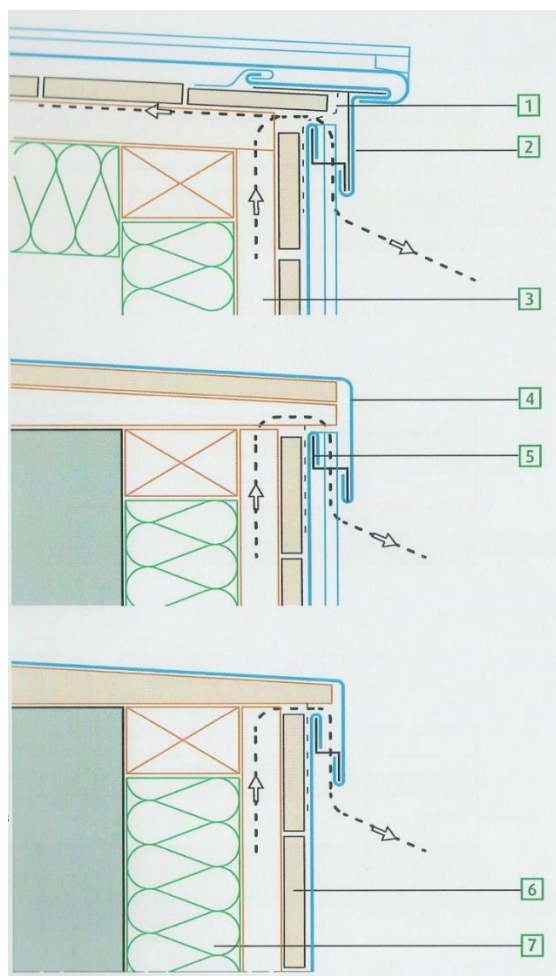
Topo de fachada, 1 – Grelha anti-insectos, 2 – Pingadeira de arranque não ventilada, 3 – Lâmina de ar, 4 – Murete, 5 – Calha, 6 – Suporte de fixação de placas de revestimento e 7 – Isolamento
